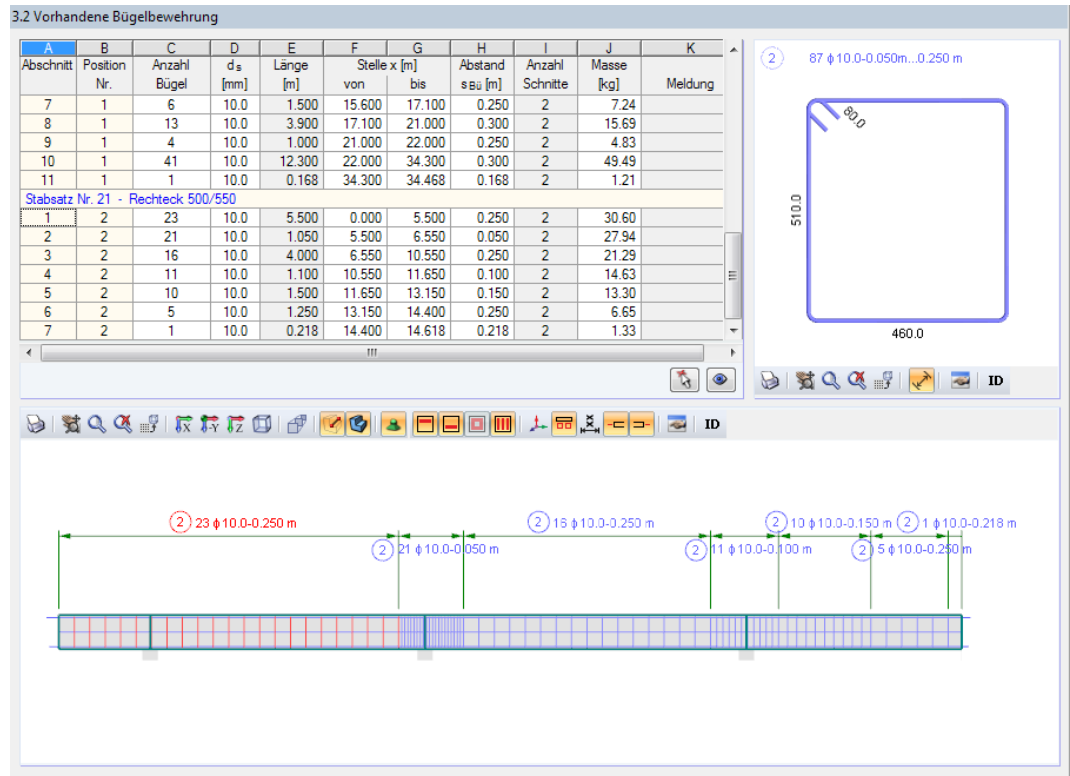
Maske 3.2 Vorhandene Bügelbewehrung
